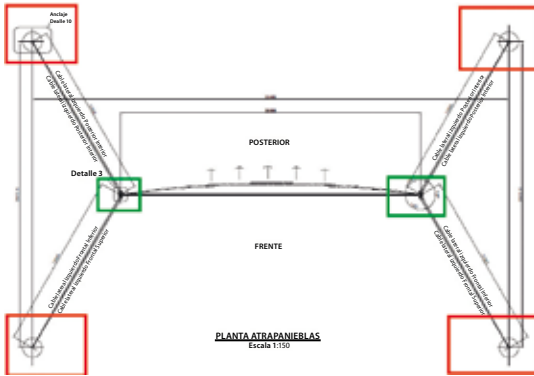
Puntos de instalación del atrapanieblas (Proyecto Atrapanieblas).
